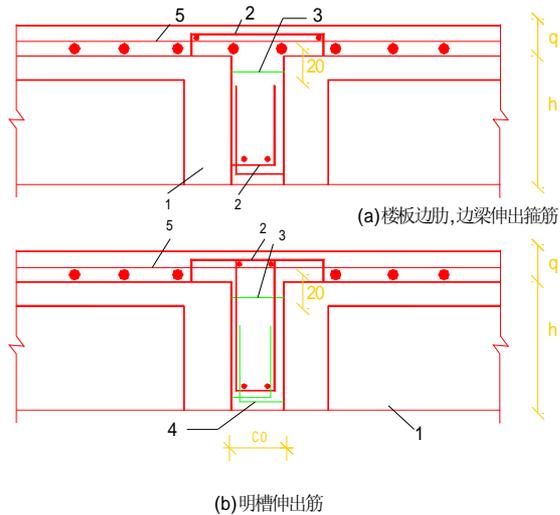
楼板边肋、边梁或明槽向叠合层伸出箍筋
